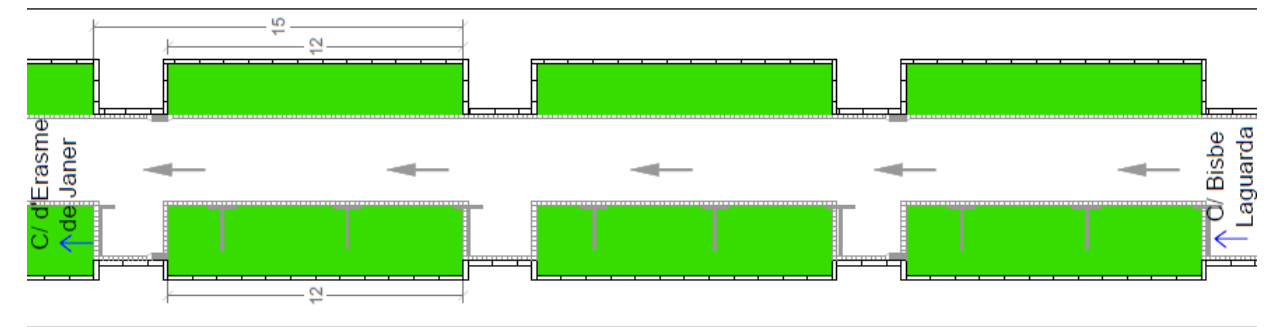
Planta de la propuesta para la C/ Riera Alta, caso c) (Tipo 2).
